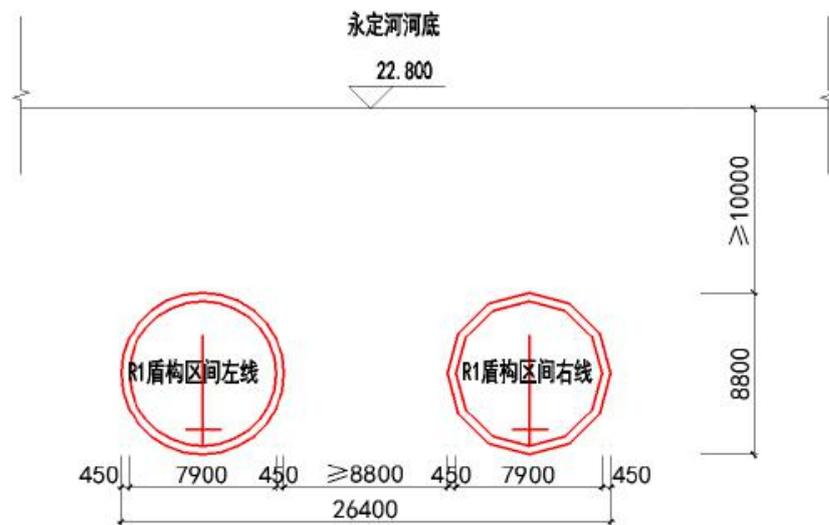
永定河穿越段横断面图 (单位: mm)
